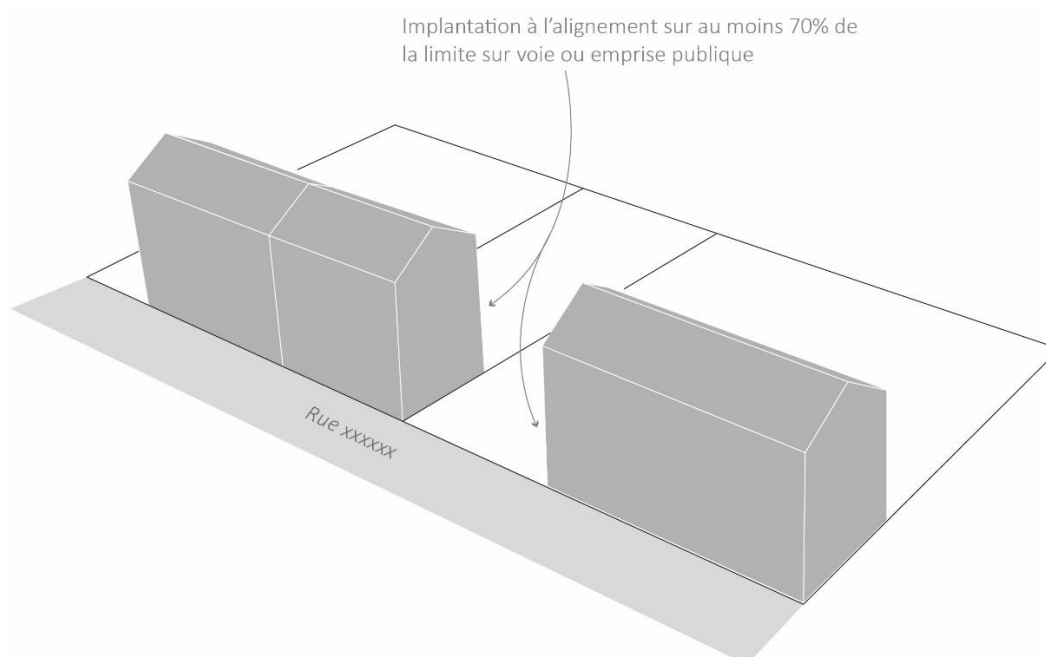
\_ Implantation des nouvelles constructions principales à l'alignement
